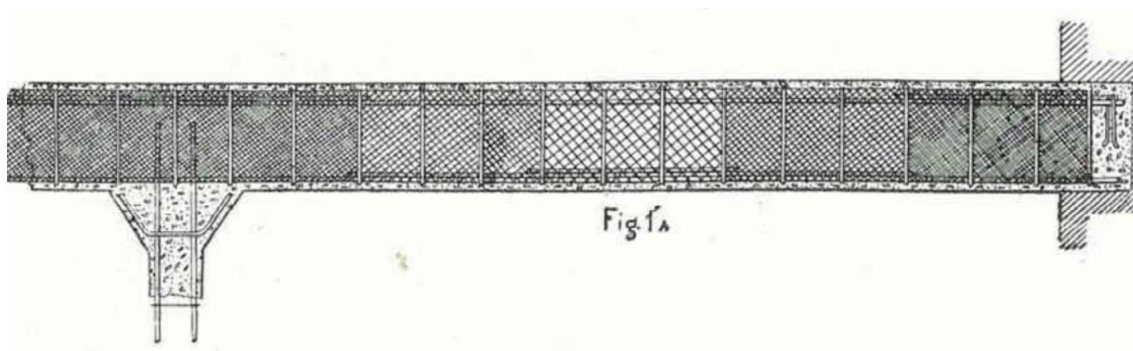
detalle del armado tipo de una viga según el Sistema Ribera. Del libro Hormigón y cemento armado de J.E. Ribera (1902).
